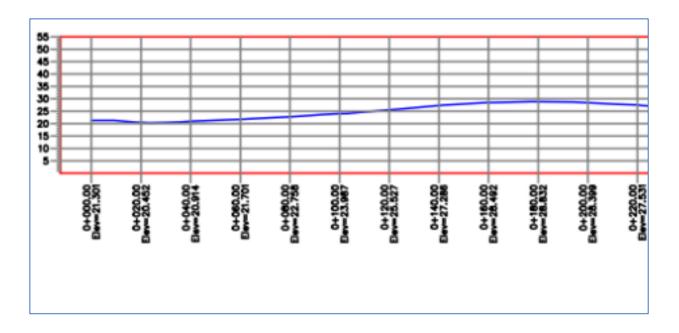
Vista 2 - Perfil longitudinal San Isidro
